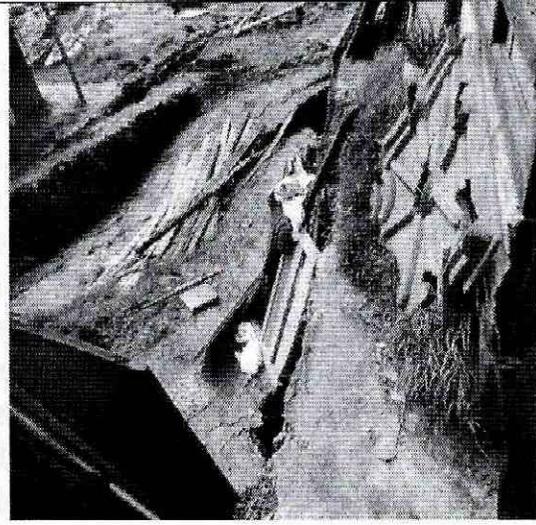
Agrietamiento del terreno donde se localizan las viviendas.
